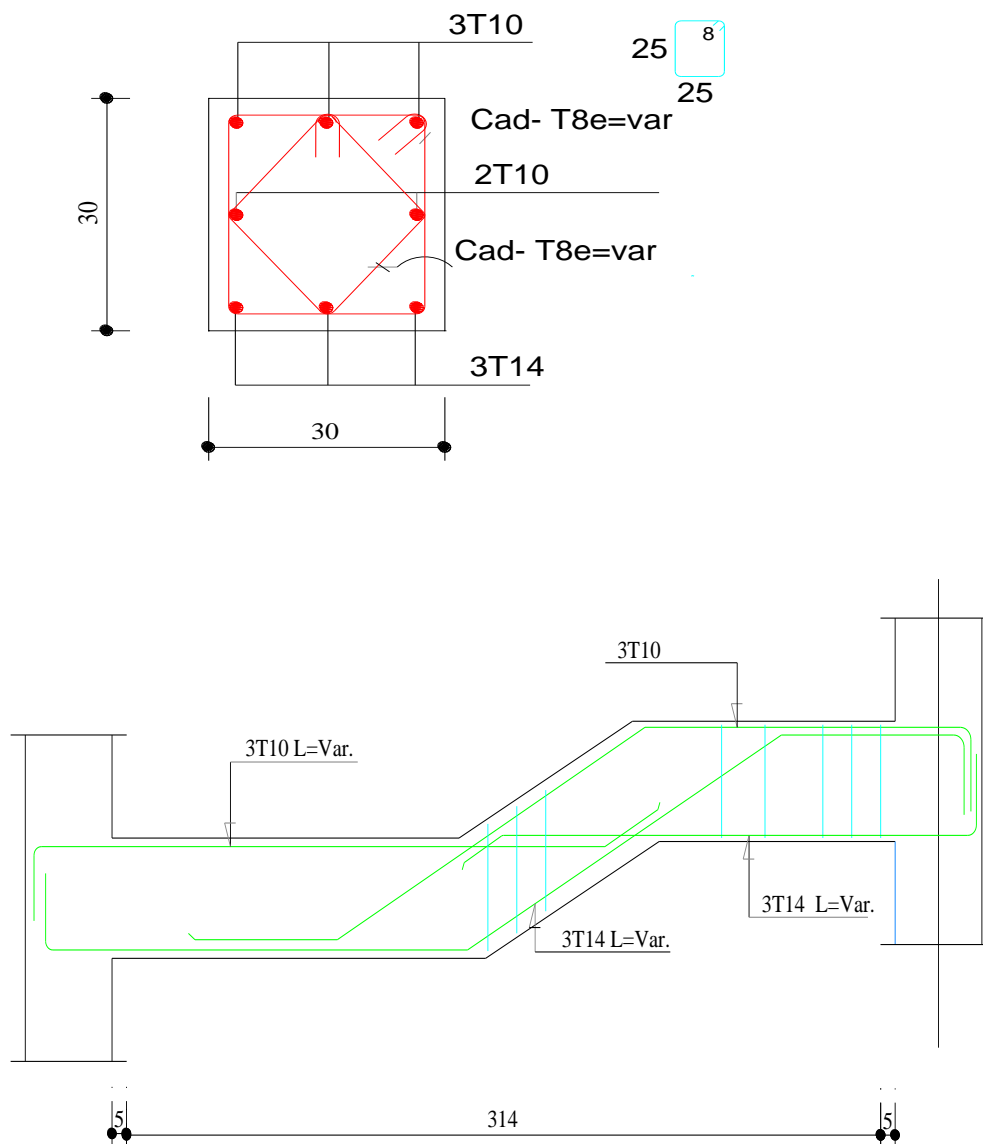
Ferrailage de la poutre palière.(escalier d'habitation)
